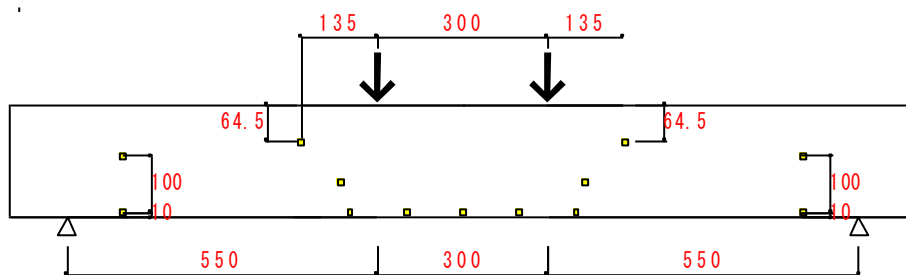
1600 mm 供試体曲げ載荷試験（単位：mm）
